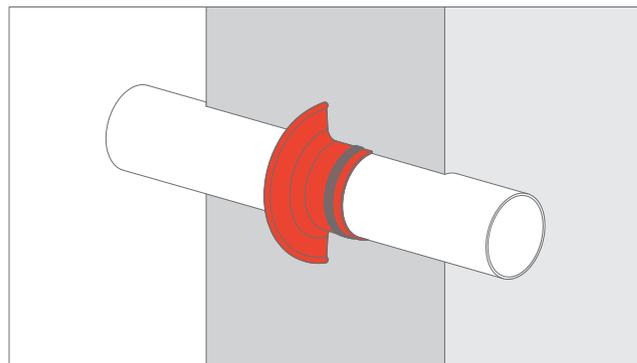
Encuentro de un muro con un elemento pasante horizontal mediante un elemento prefabricado embebido
